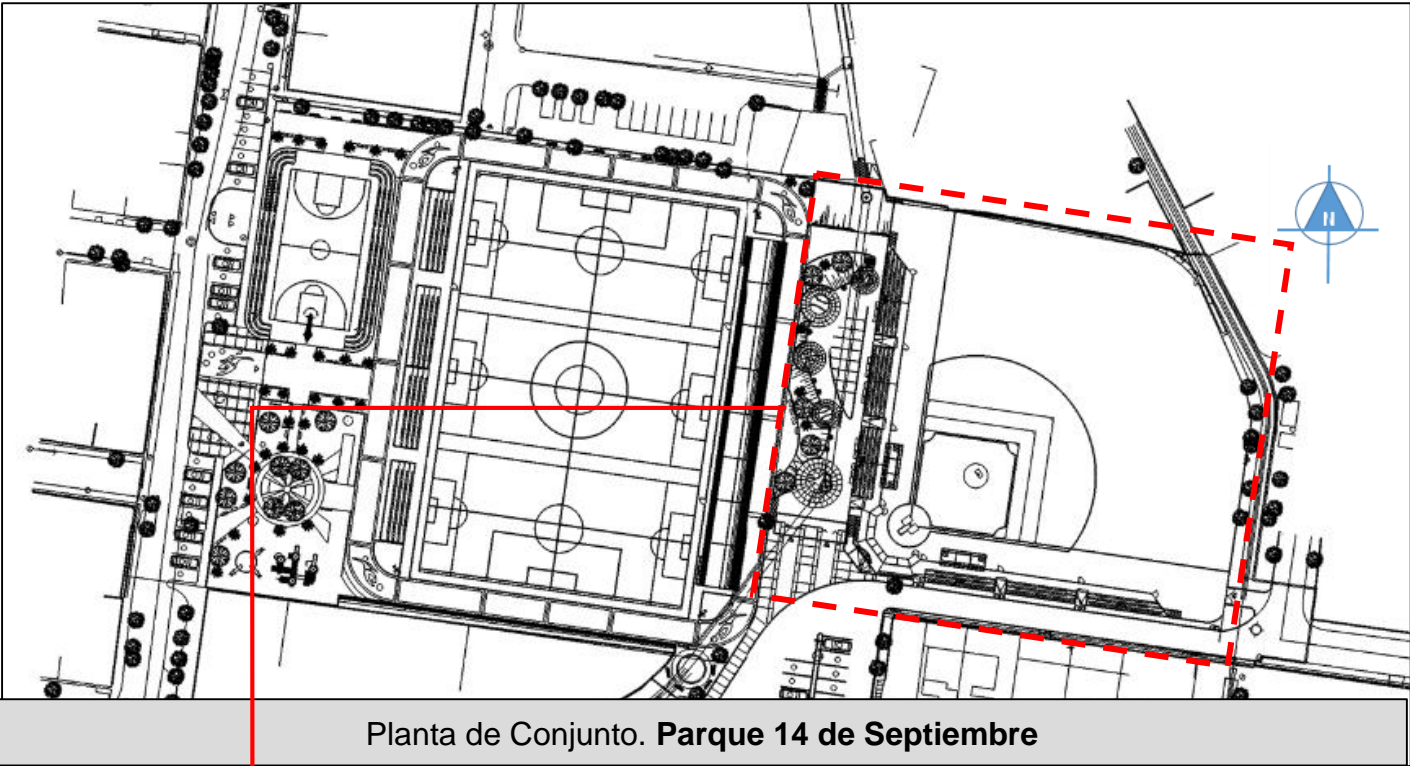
Etapa 1. Planta Arquitectónica del Estadio de Béisbol
